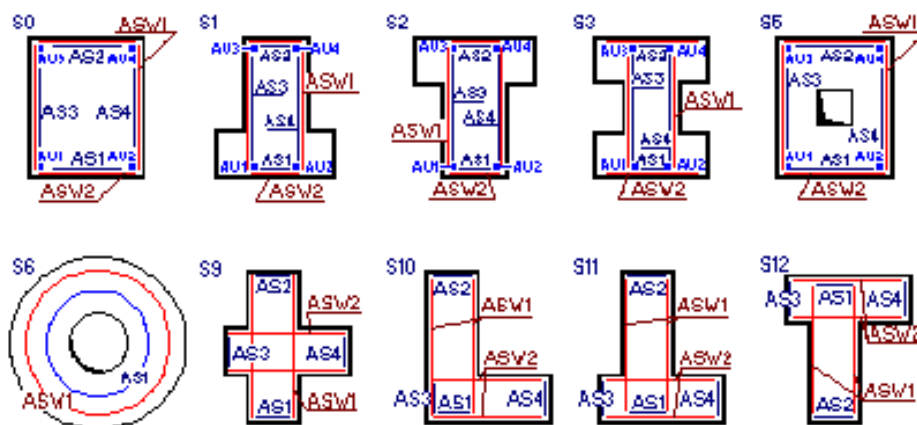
Типы сечений для армирования и схемы армирования.
